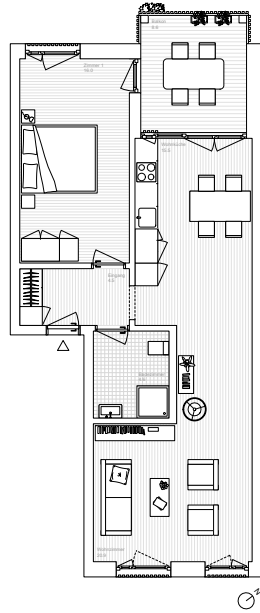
Waldarena: 2.5-Zimmer Wohnung
